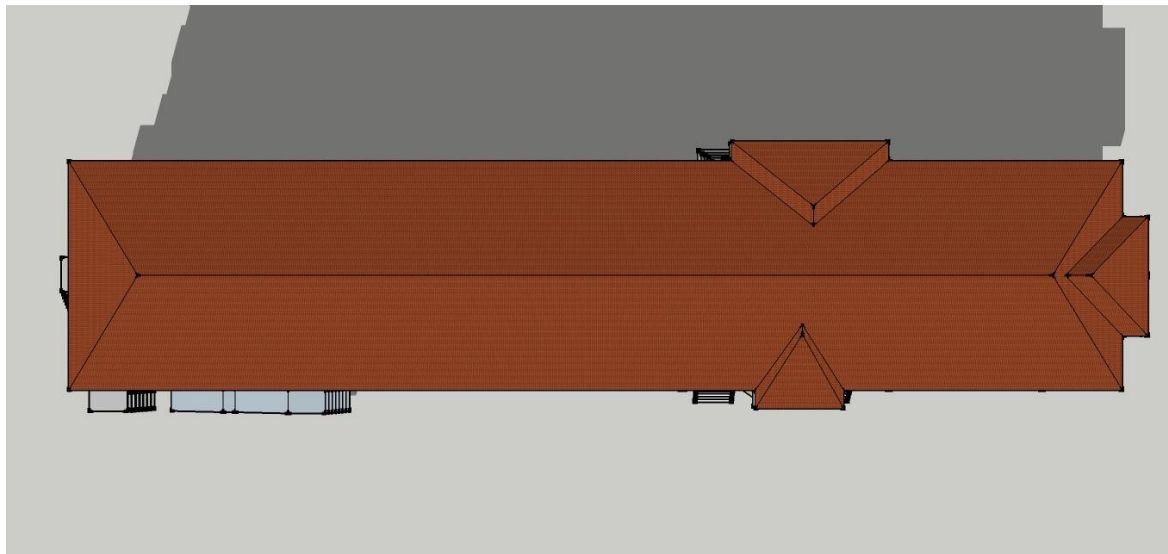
Vista en planta del Edificio Isaac Peral modelado en SketchUp
